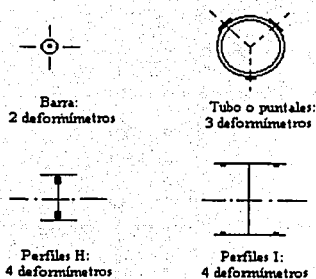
Lugares típicos para fijar deformímetros eléctricos en elementos estructurales de acero
